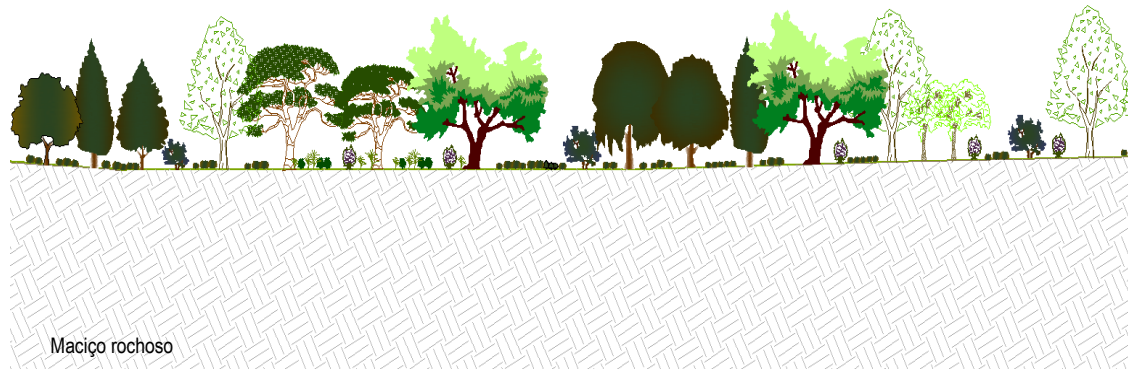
Perfil esquemático da recuperação paisagística nas áreas infraestruturadas.
